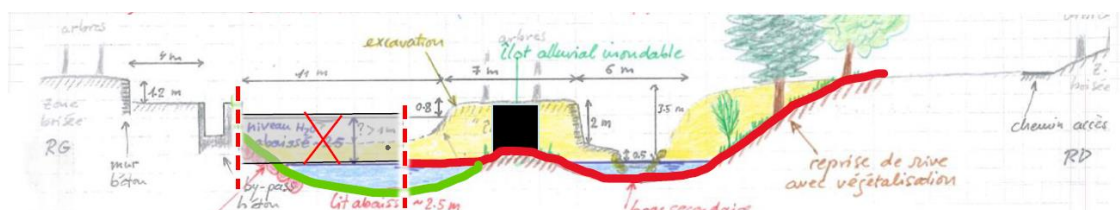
Étape 3 des travaux dans le secteur du seuil (construction de la rive gauche) - profil-type
